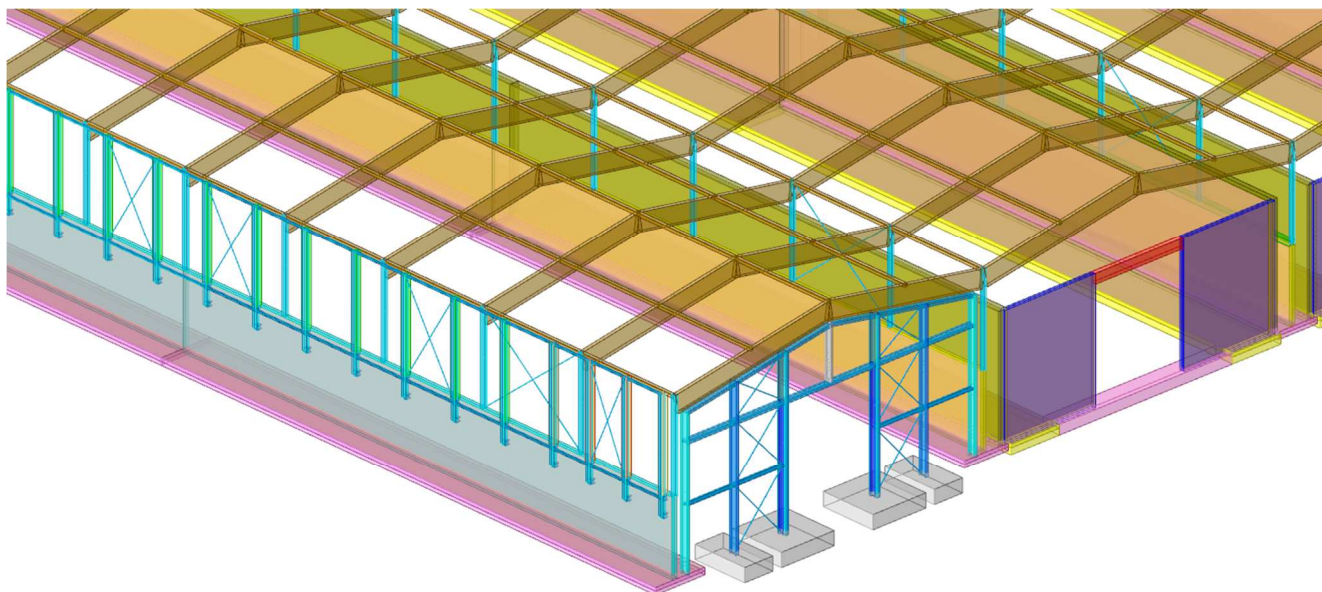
dettaglio modellazione FEM tamponamento e stoccaggio
